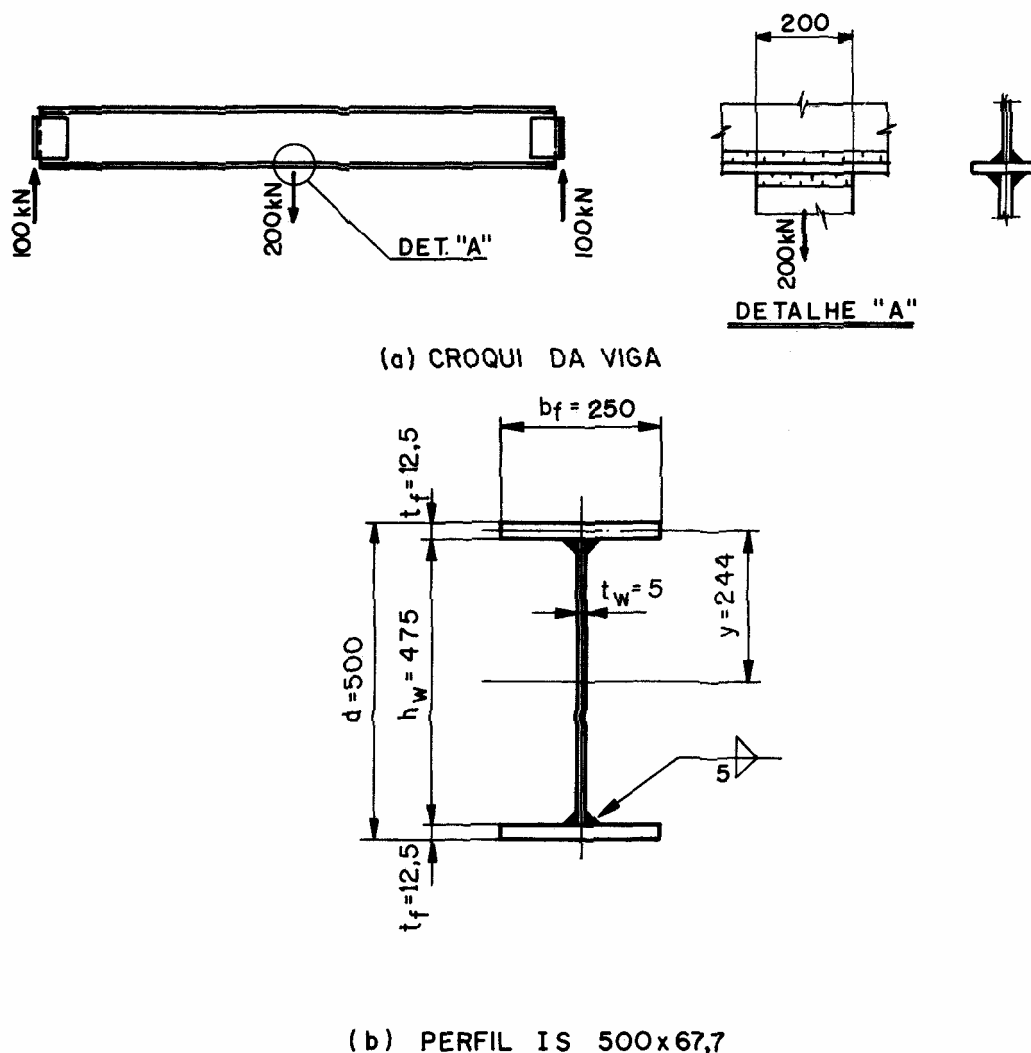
Solda de Composição de Perfil Soldado
